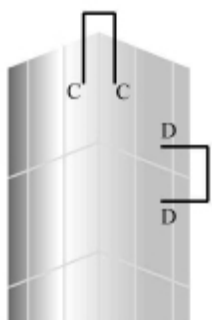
A: Detail příčky. Příklad řešení strukturálního spoje: 2-stranné řešení (instalované na staveništi).
